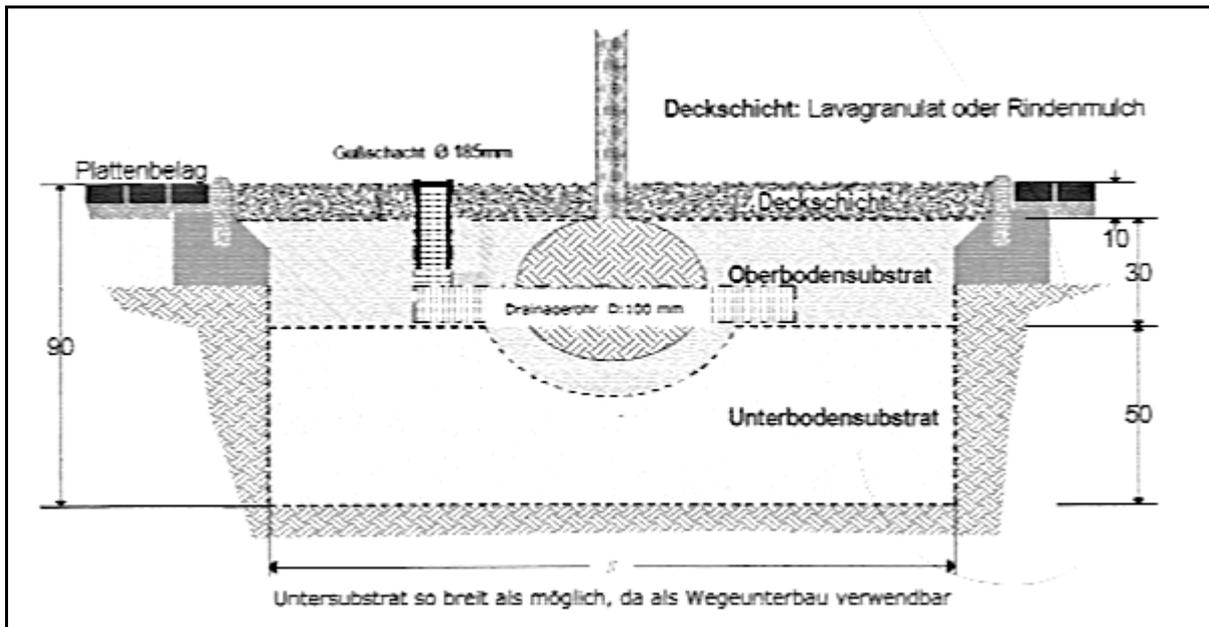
Richtlinie der Wiener Stadtgärten für eine Baumscheibe mit Gulsschacht und Ringdrain
